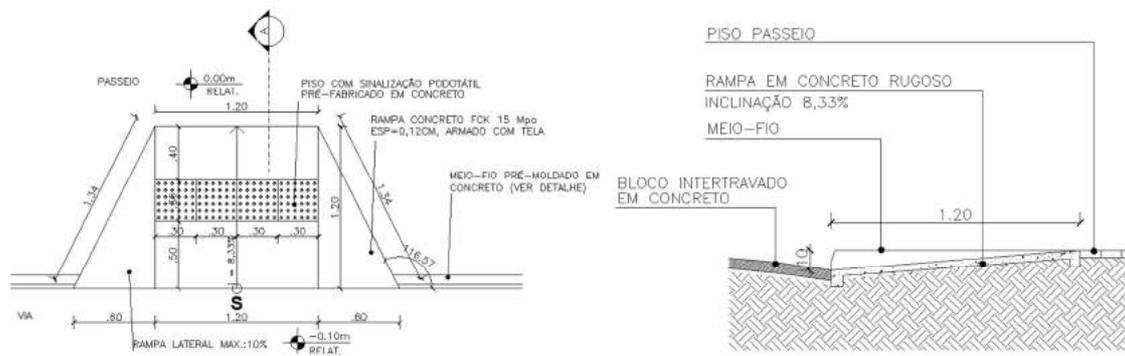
MODELO DE REBAIXO DE CALÇADA – PLANTA E CORTE
